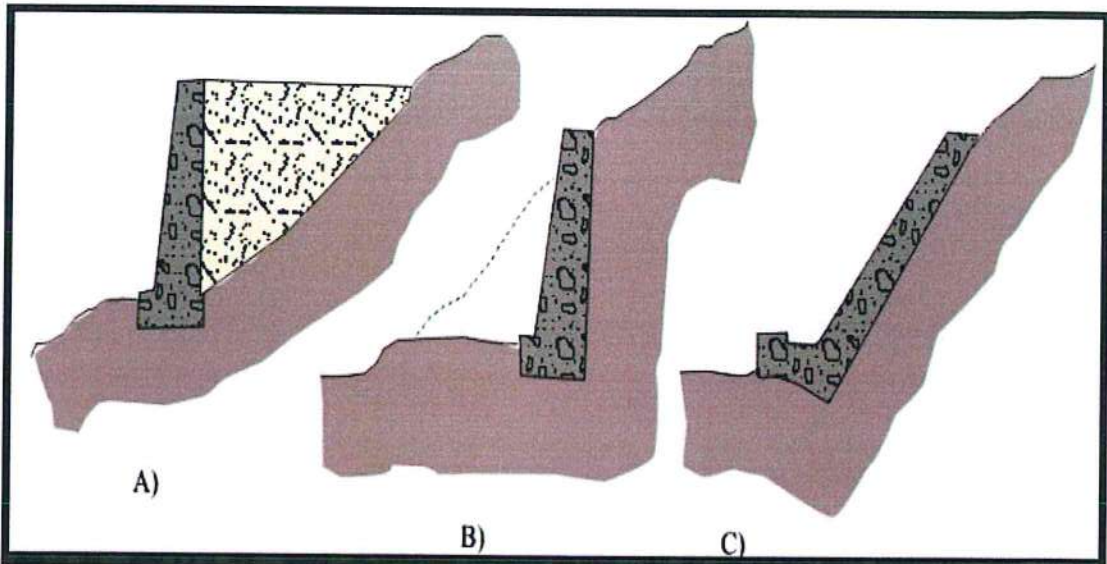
A) Muro de sostenimiento, B) Muro de contención, C) Muro de revestimiento (INGEMMET, 2000).
